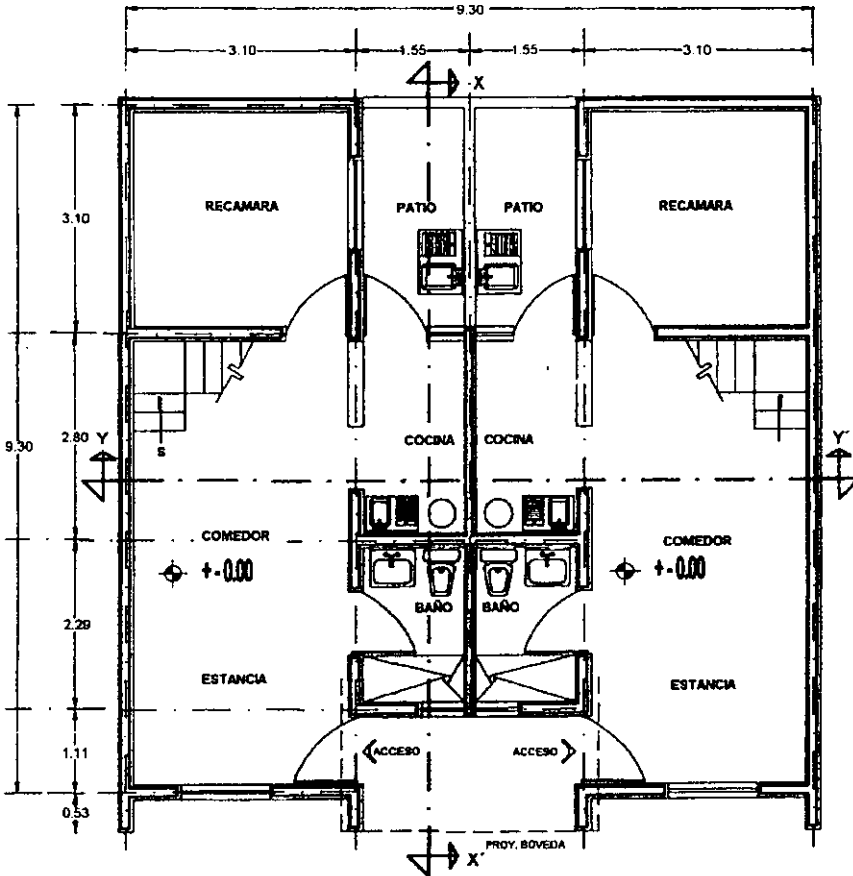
Fraccionamiento Ganaderos I; planta baja.
